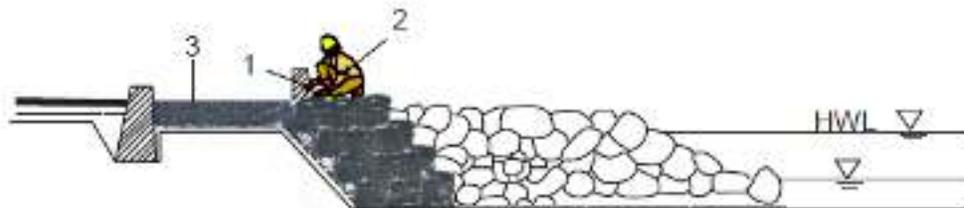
Penyusunan buis beton dan pengisian beton cyclop
